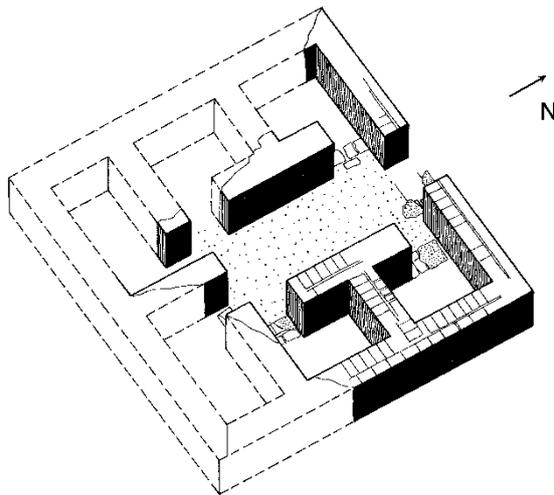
Plan Haus 28636 (nach Mazar 2006, 269, fig. 8.26)
